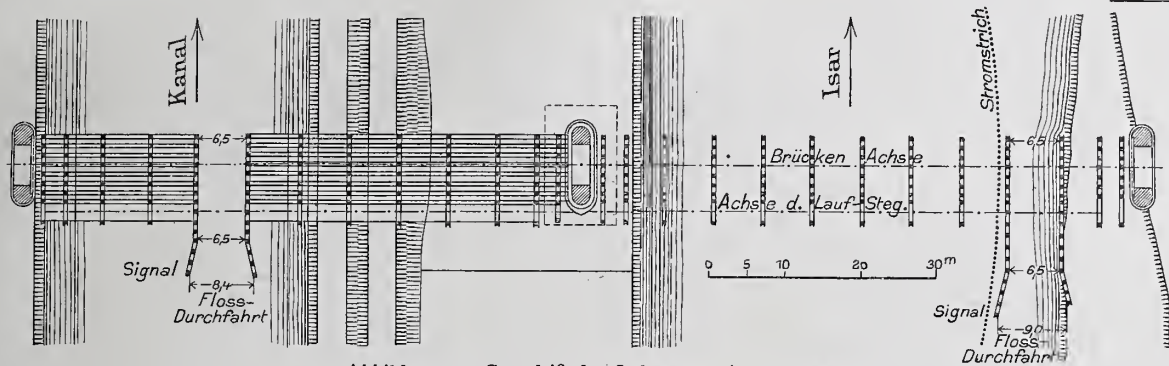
Grundriß der Lehrgerüst-Anordnung.
